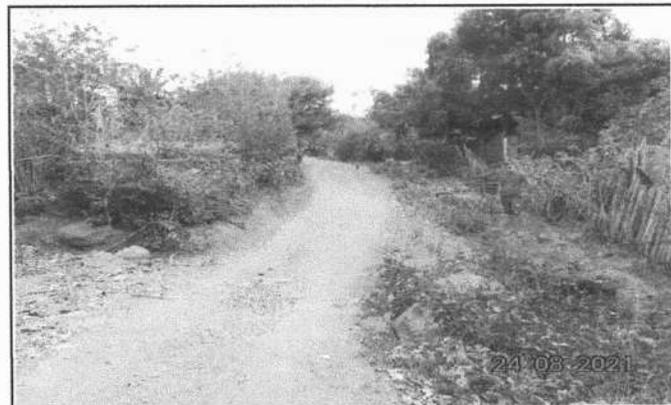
LOCAL DA CONSTRUÇÃO-BUEIRO
